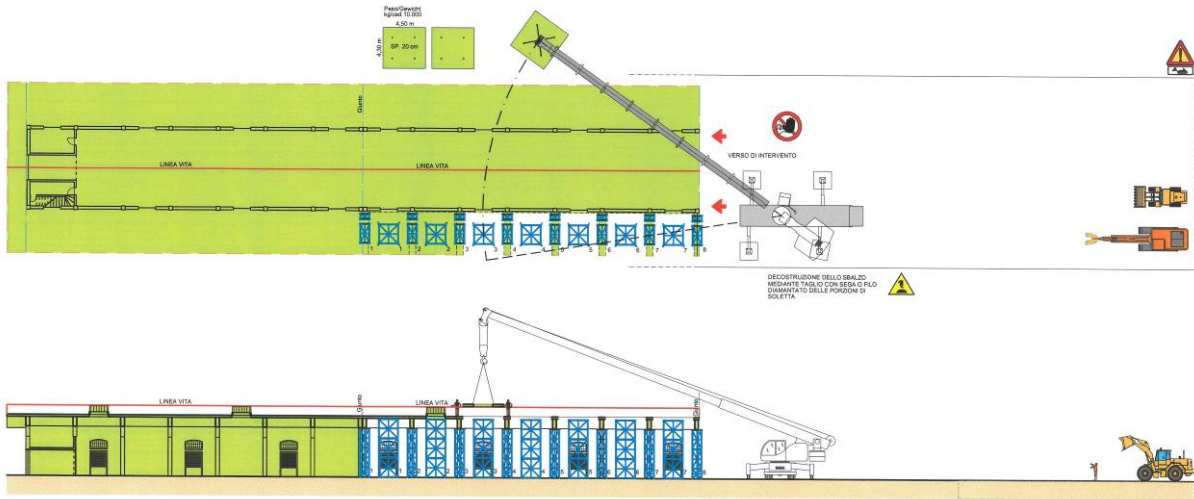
Planimetria e vista longitudinale Demolizione Edificio A9 – Decostruzione soletta
